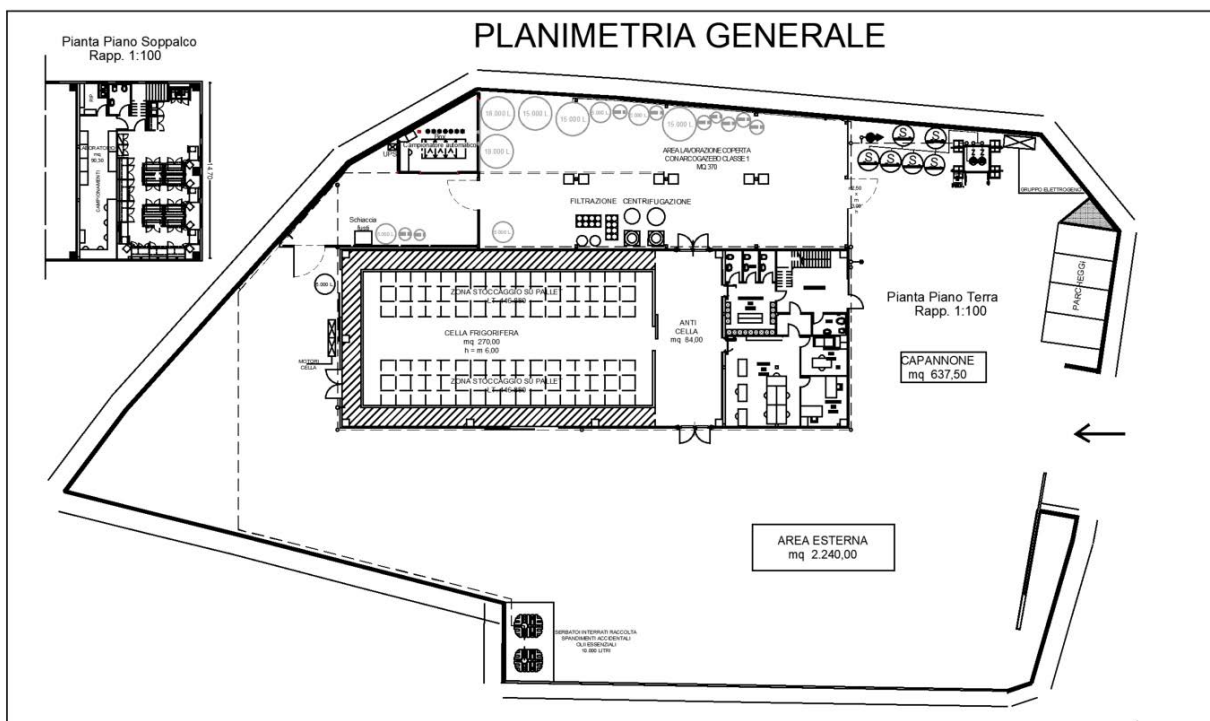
Planimetria Generale Stabilimento Attuale Oli Essenziali
